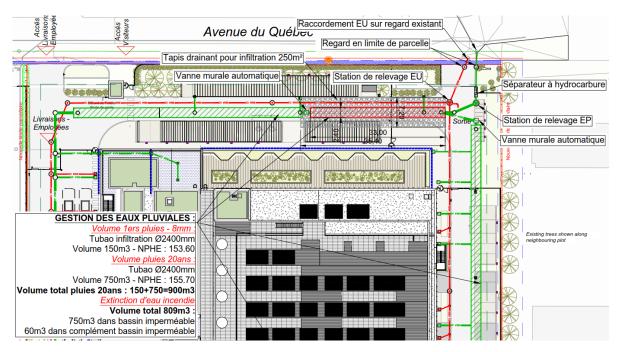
Plan de gestion des eaux pluviales de la partie Nord du site
